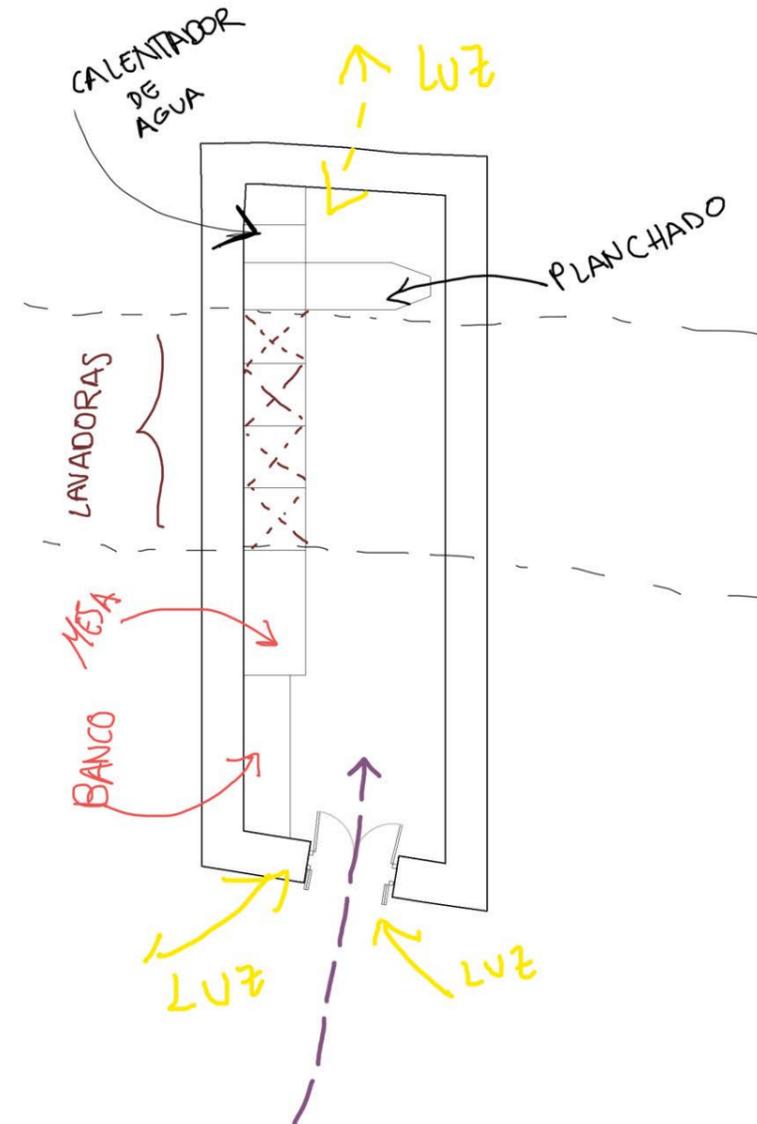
Esquema de la lavandería. Fuente:elaboración propia
